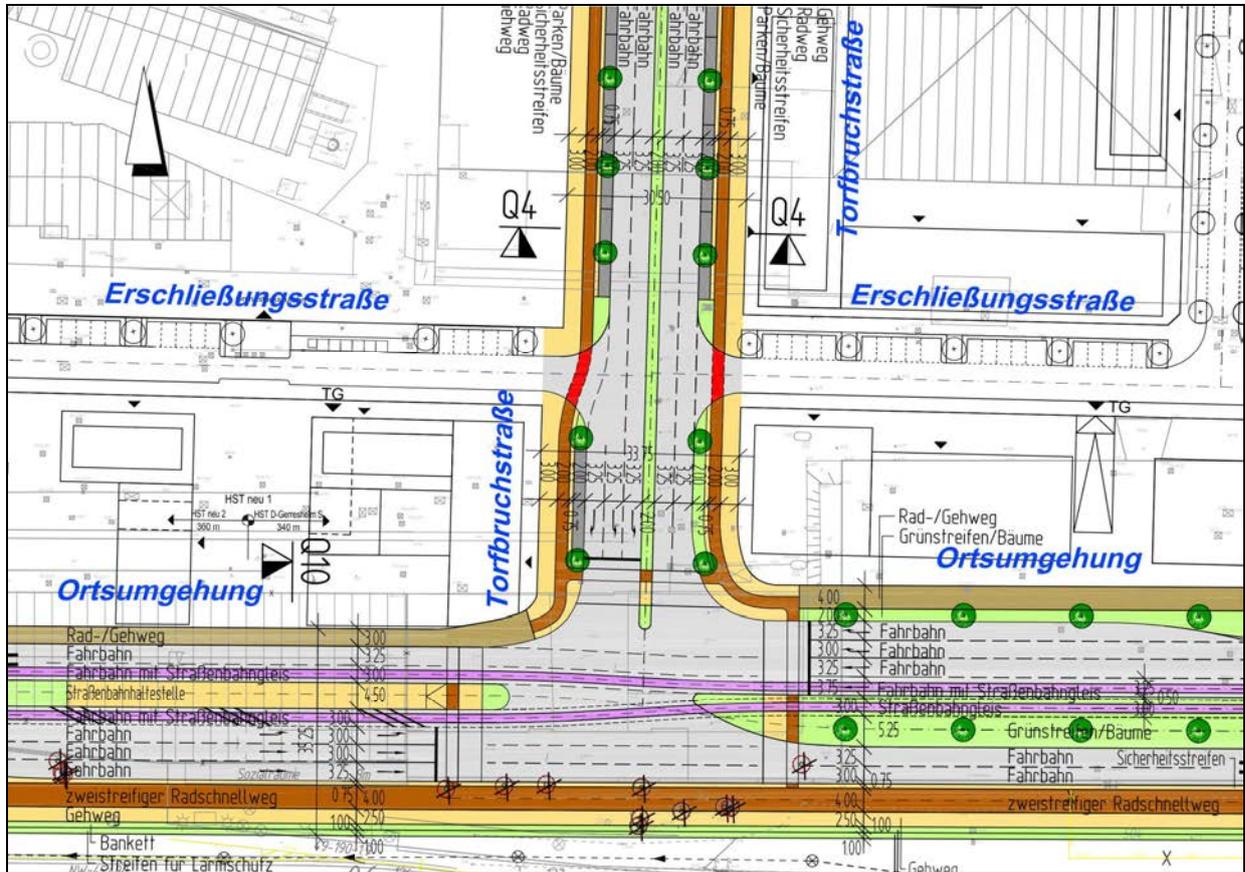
Knotenpunkt Torbruchstraße/Erschließungsstraße (Planstraßen 3 und 10)
